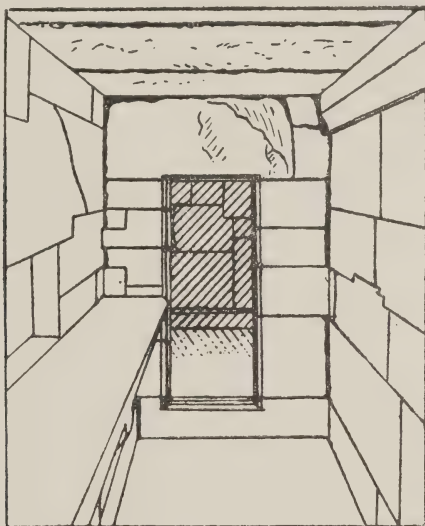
Cámara del fondo de la nave derecha, con su puerta de entrada.
